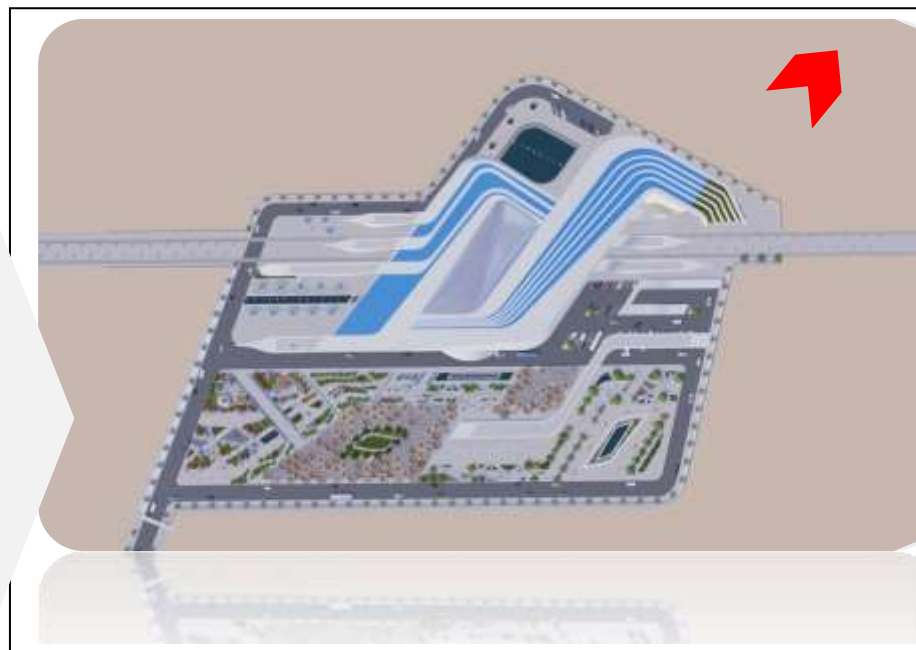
rendu plan de masse finale de la gare ferroviaire à Laghouat. Source : Auteur
